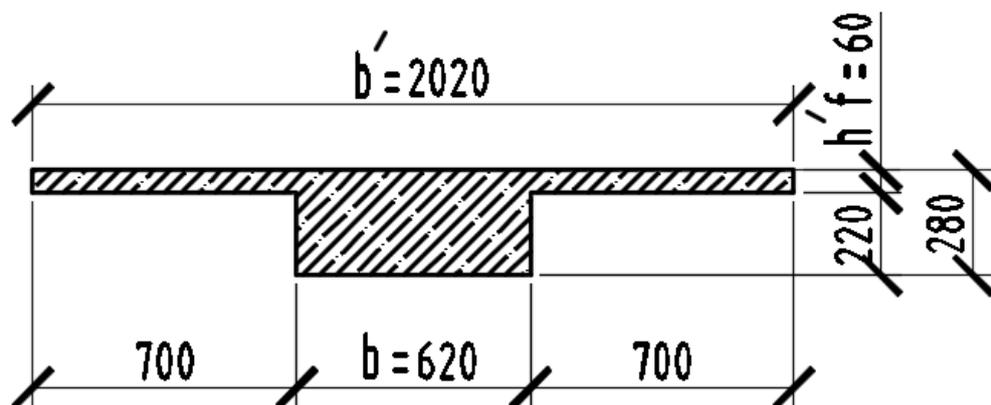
Расчётная схема поперечного сечения монолитного ригеля.
